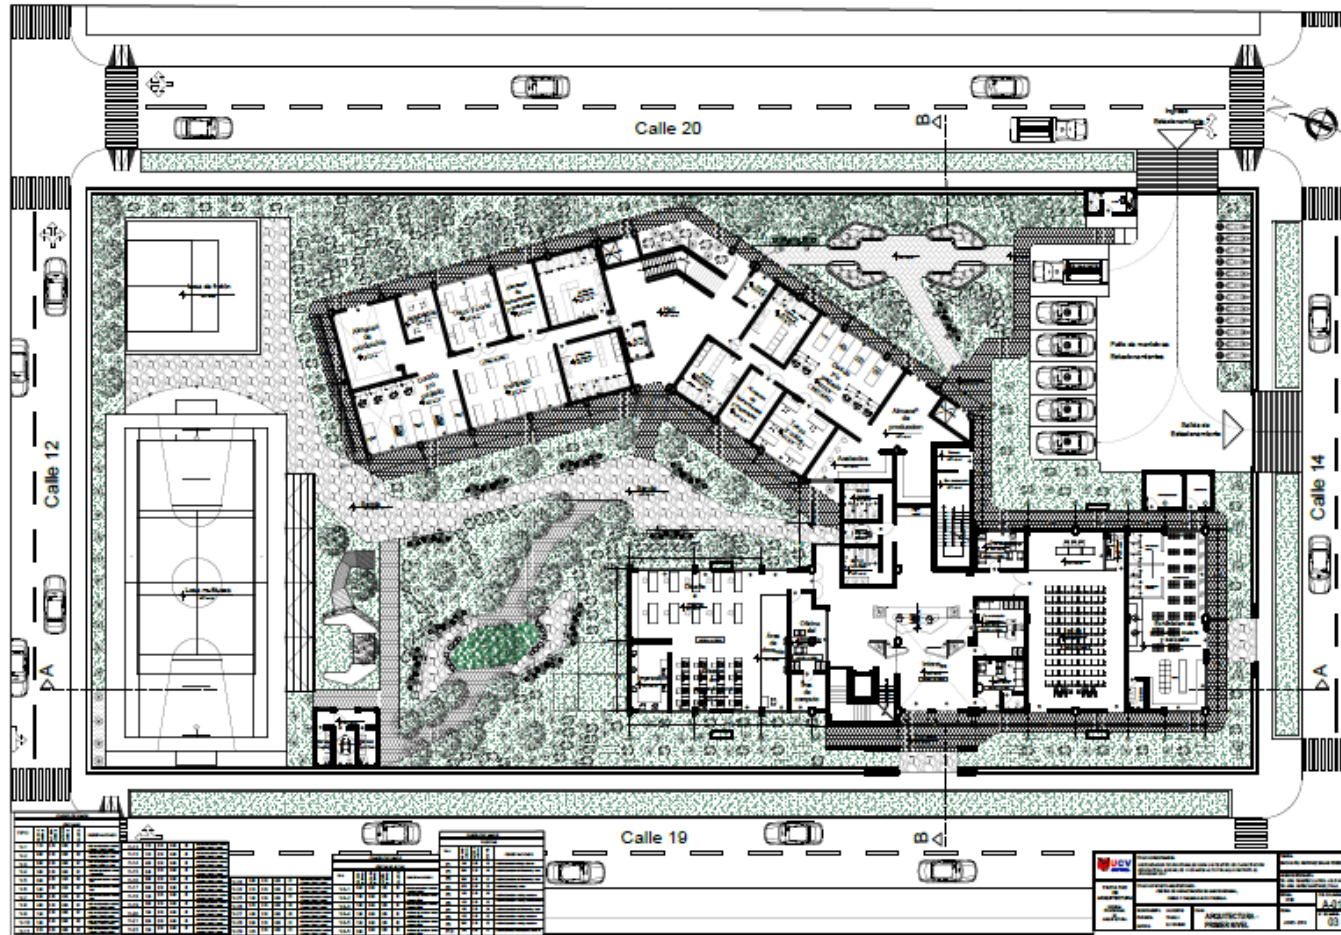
Plano de distribución general-Plano N°03-Lámina A01
